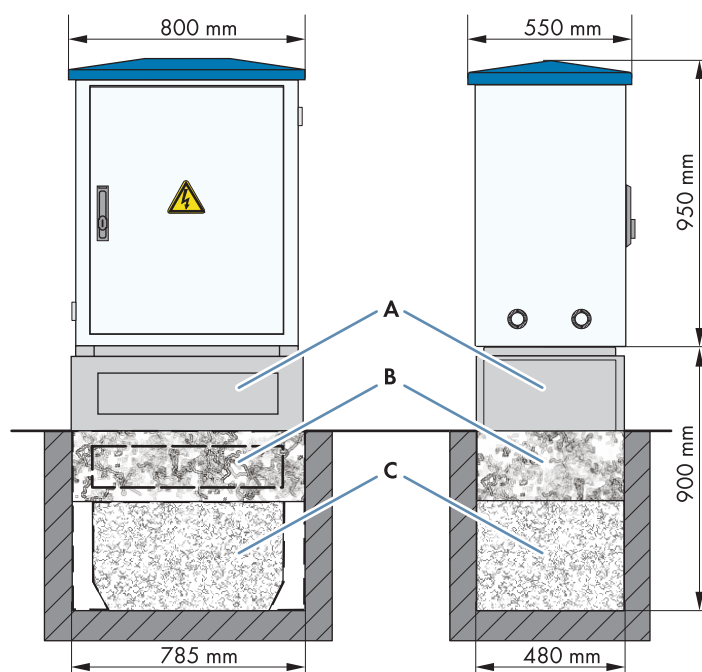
Dimensions de la Sunny Main Box Cabinet pour le montage sur socle
